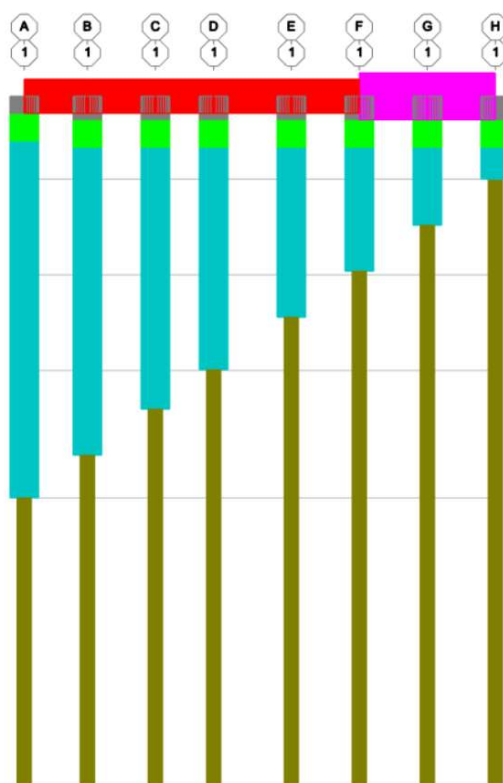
Modelo estructural del segmento de muelle N3 - Vista transversal típica
